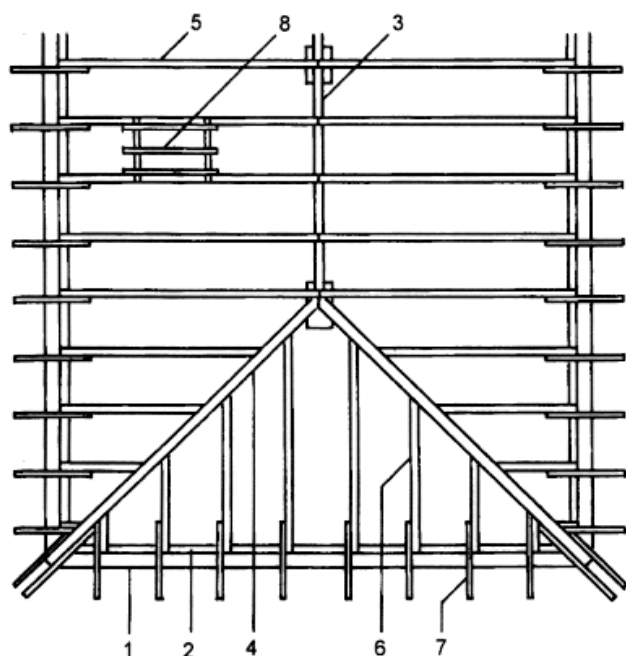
Фрагмент плана стропил вальмовой крыши:
